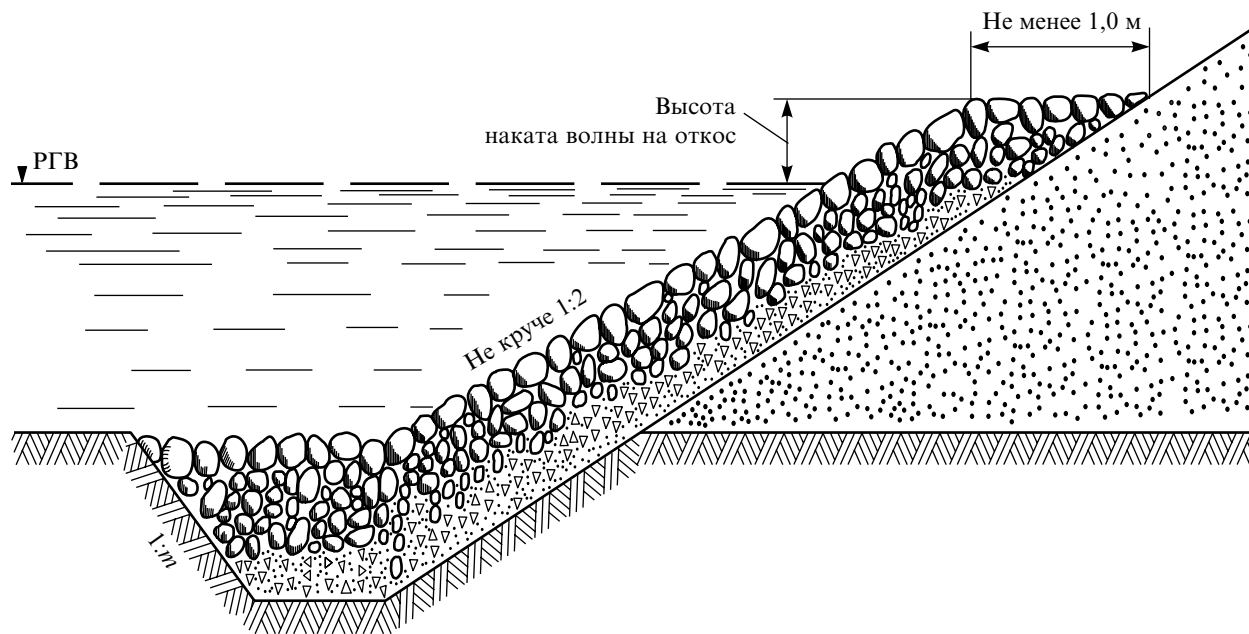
Укрепление откоса каменной наброской с устройством рисбермы при размываемых грунтах основания, РГВ — расчетный горизонт воды
